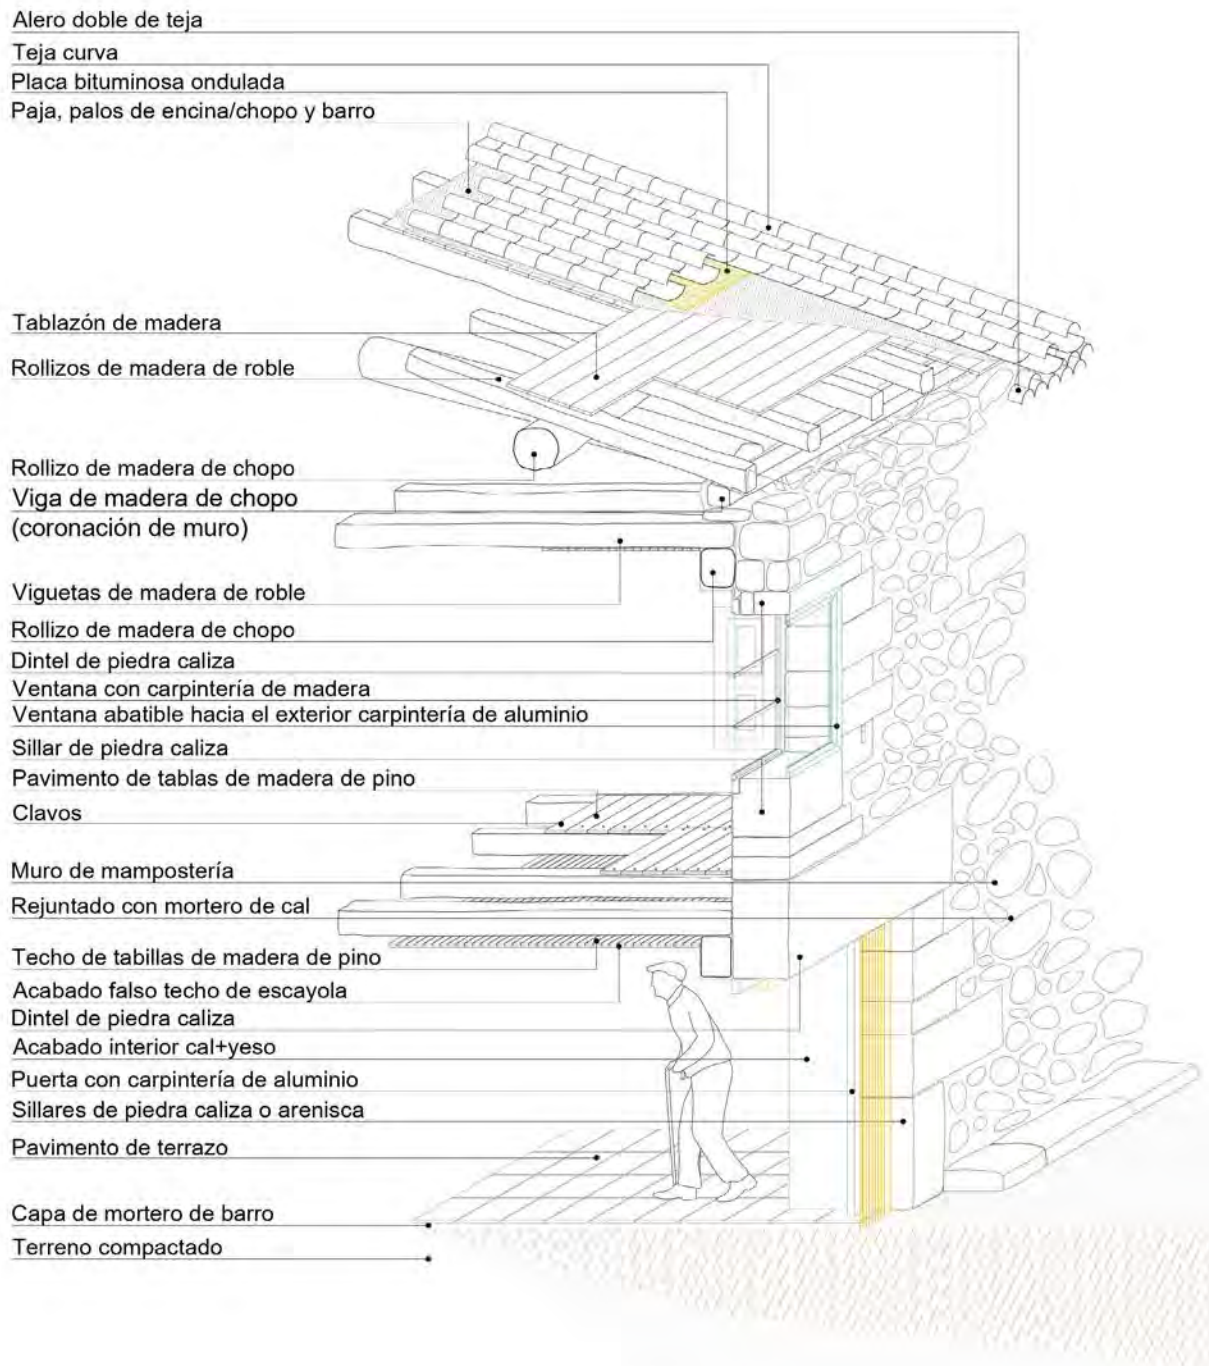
Axonometría constructiva entrada vivienda de estudio.
